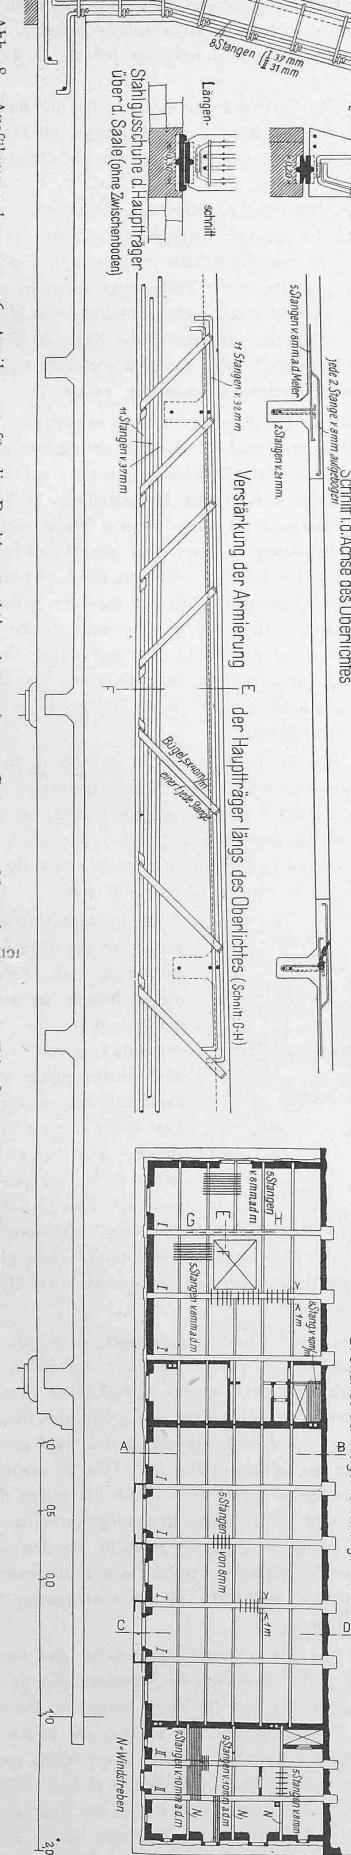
Ausführungsplan vom 26. April 1905 für die Dachkonstruktion in armiertem Beton. — Massstab 1:50. — (Die Schnitte A-B und C-D in 1:500 sind den Plänen der Bauleitung entnommen.)
